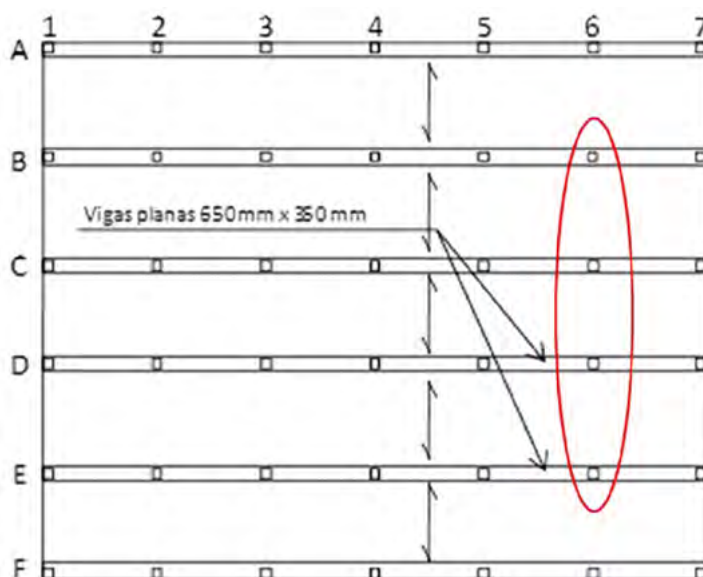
Croquis de la estructura de la planta de cubierta. Se señalan los pilares que fueron retirados para crear el salón de actos.
